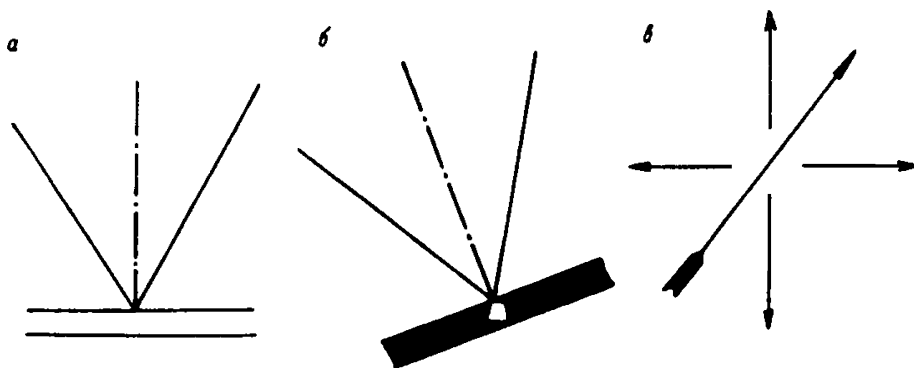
Схемы заложения скважин для определения трещиноватости пород кровли
